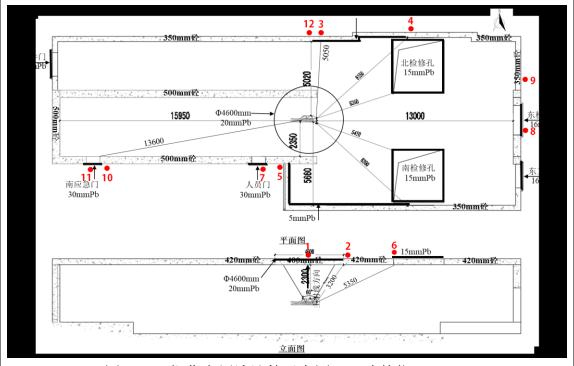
探伤室周边计算示意图(尺寸单位; mm)
